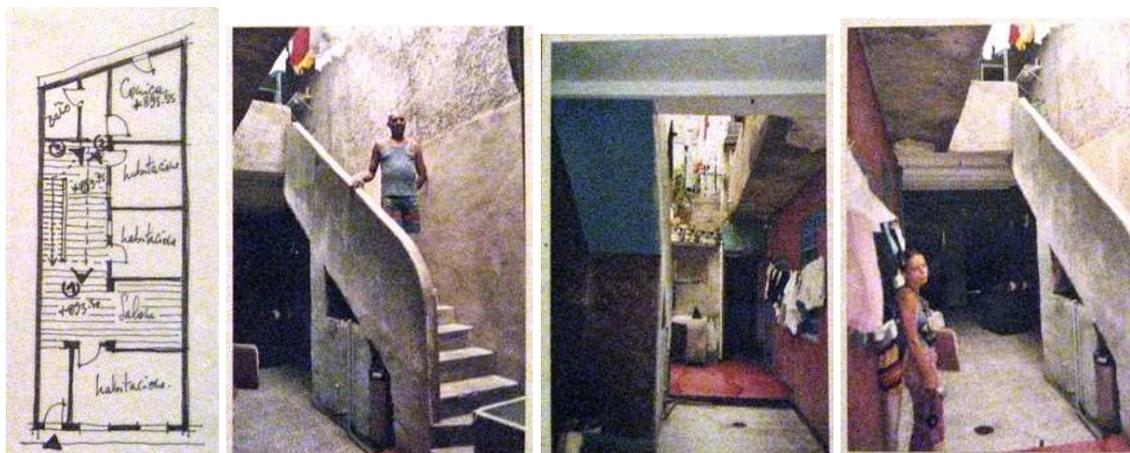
Interior de viviendas en el Barrio Marín. S/F.
